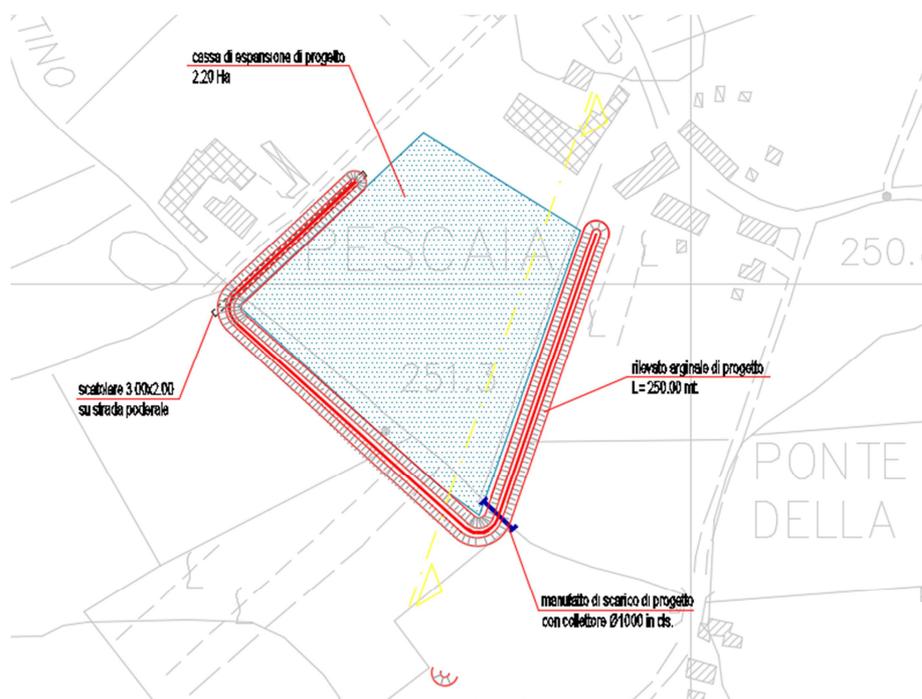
Indicazione planimetrica cassa laminazione a monte Via Chiana - Ipotesi 2
